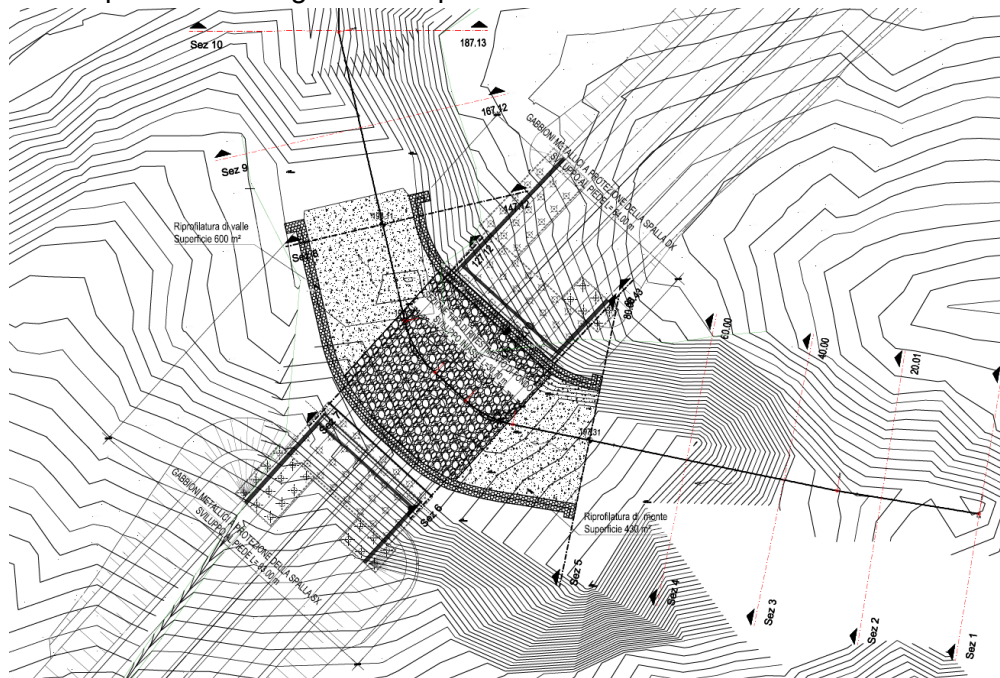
Planimetria di intervento sull’impluvio “Opera 3”
